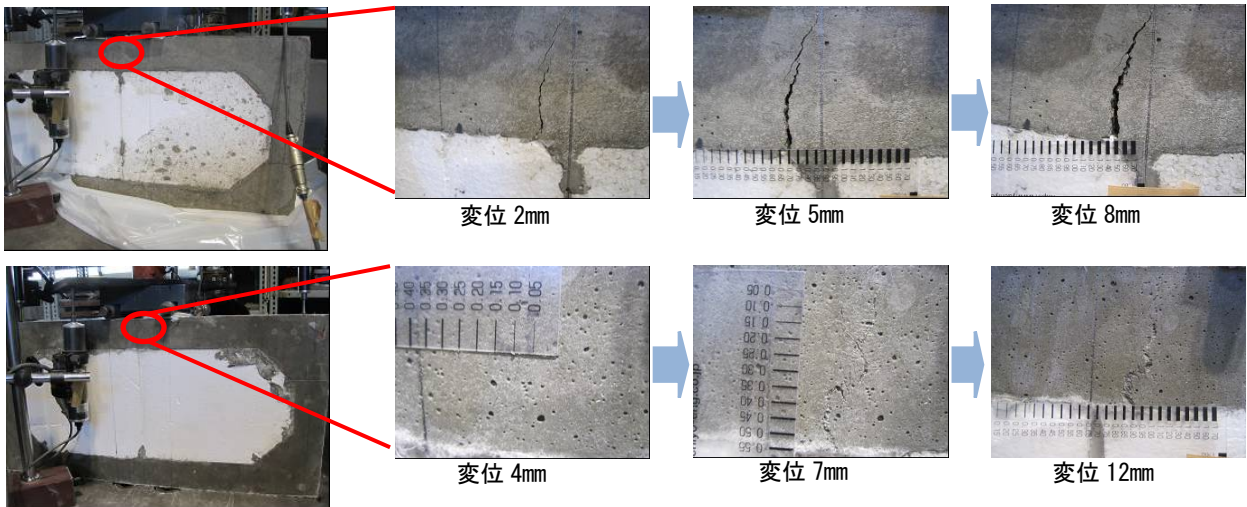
ブロック供試体のひび割れ状況 (上: Block-NC 下: Block-HP)
